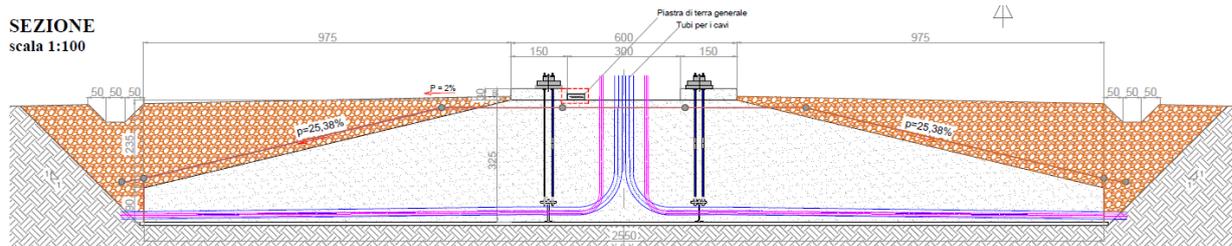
Geometria della fondazione diretta dell'aerogeneratore
